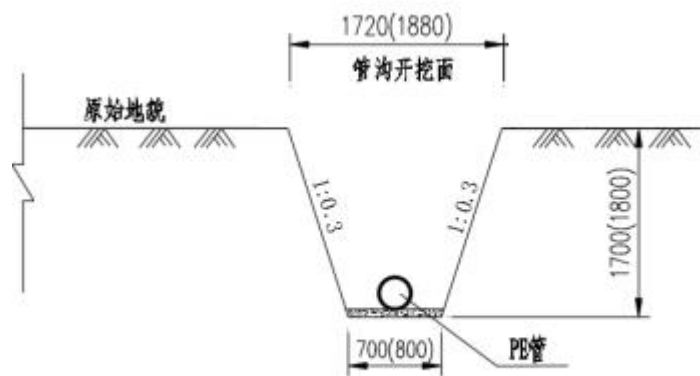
扬水管道管沟开挖断面图（单位：mm）
